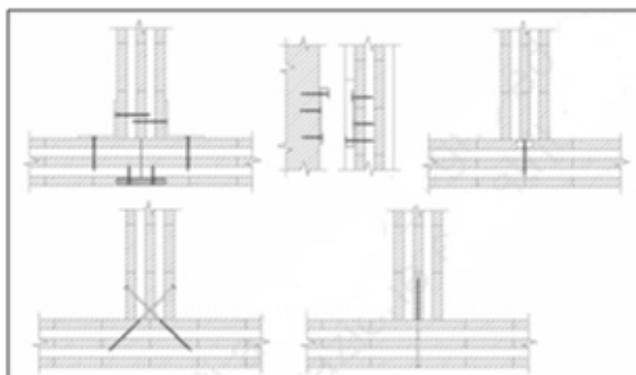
Collegamento parete - parete: alcune soluzioni costruttive
